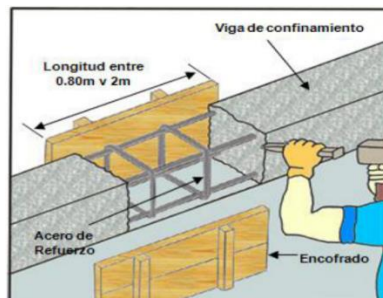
Preparación de la Viga de Confinamiento. Recuperado de: Elaboración propia.
